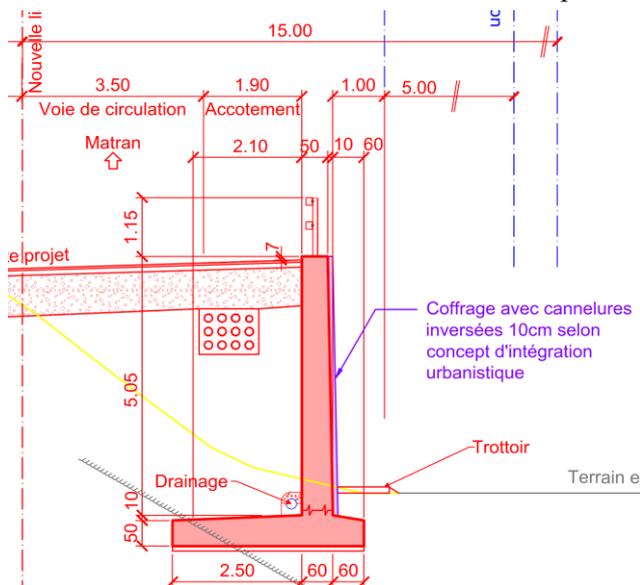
Section type du mur des Fontanettes aval avec fondation superficielle
